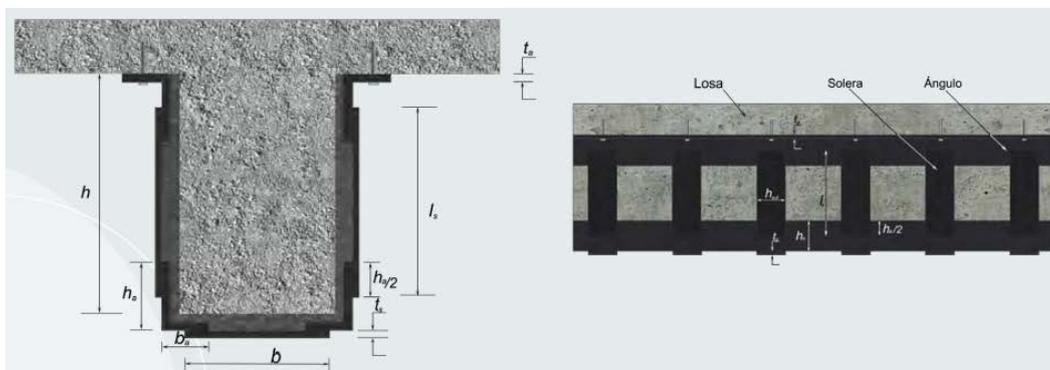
Encamisado de viga, mediante angulares y pletinas de acero: izquierda, sección transversal; derecha, sección longitudinal.
